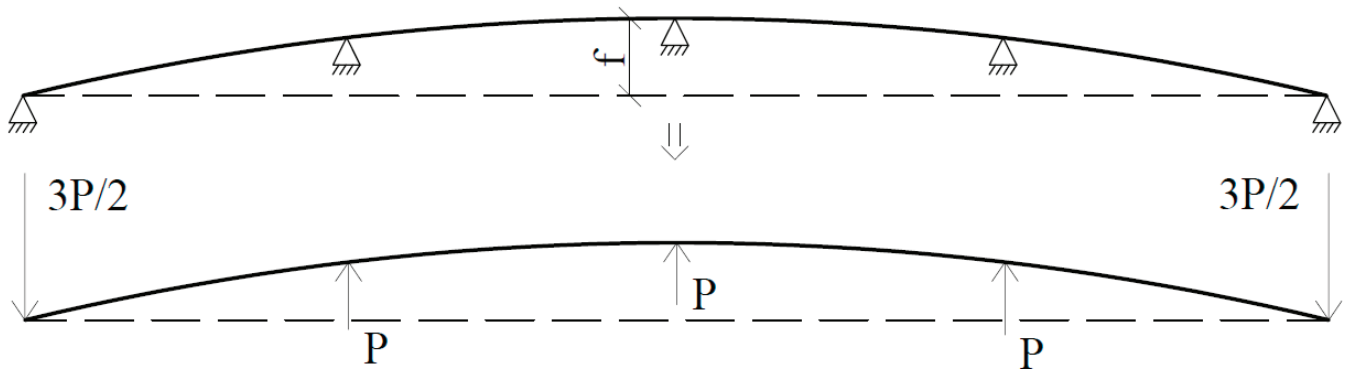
Схема монтажных опорных реакций в четырехпролетной схеме
